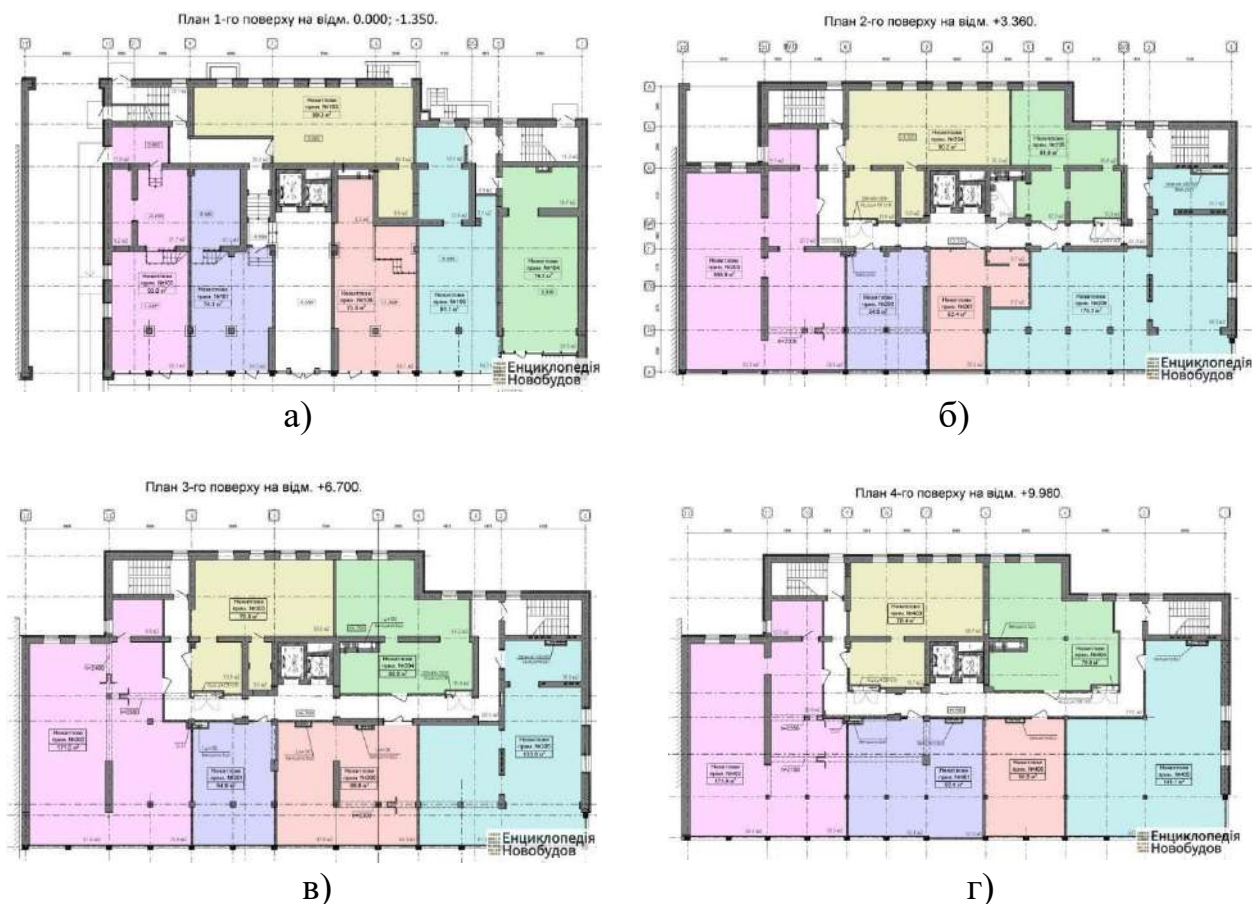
а) – план 1-го поверху; б) – план 2-го поверху; в) – план 3-го поверху; г) – план 4-го поверху. [50]
